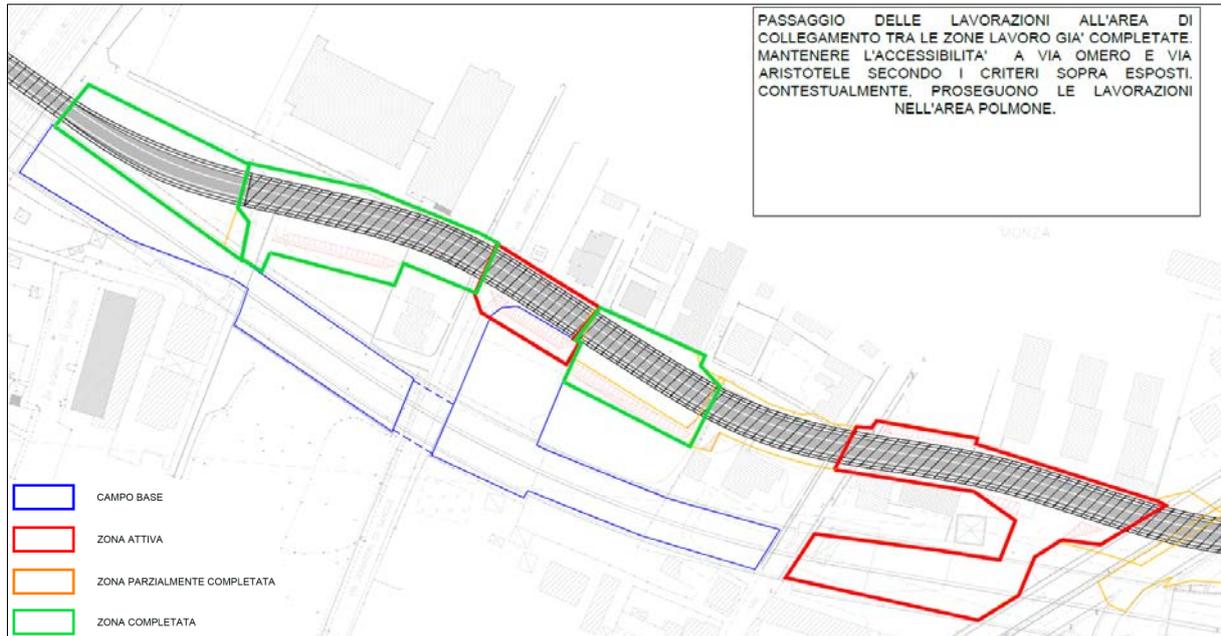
Fasi realizzazione copertura galleria del Piano di Sicurezza di progetto illustrativo della fase E di scavo della galleria
